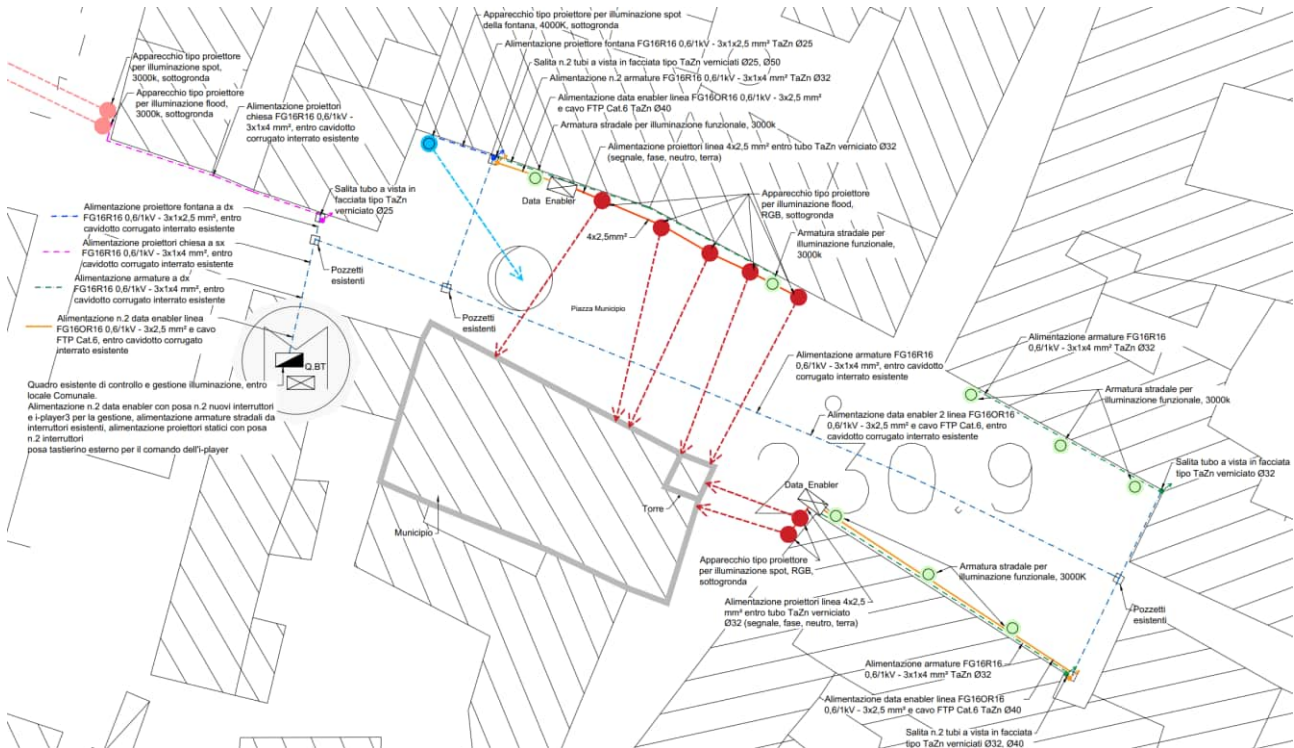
Planimetria di progetto illuminazione Chiesa di San Giovanni e Piazza Municipio
